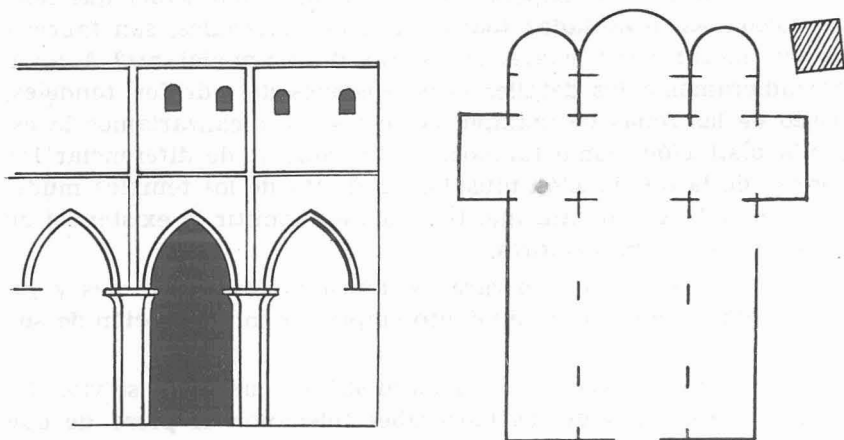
Planta y alzado de Santiago del Arrabal (siglo XIII). Toledo.
